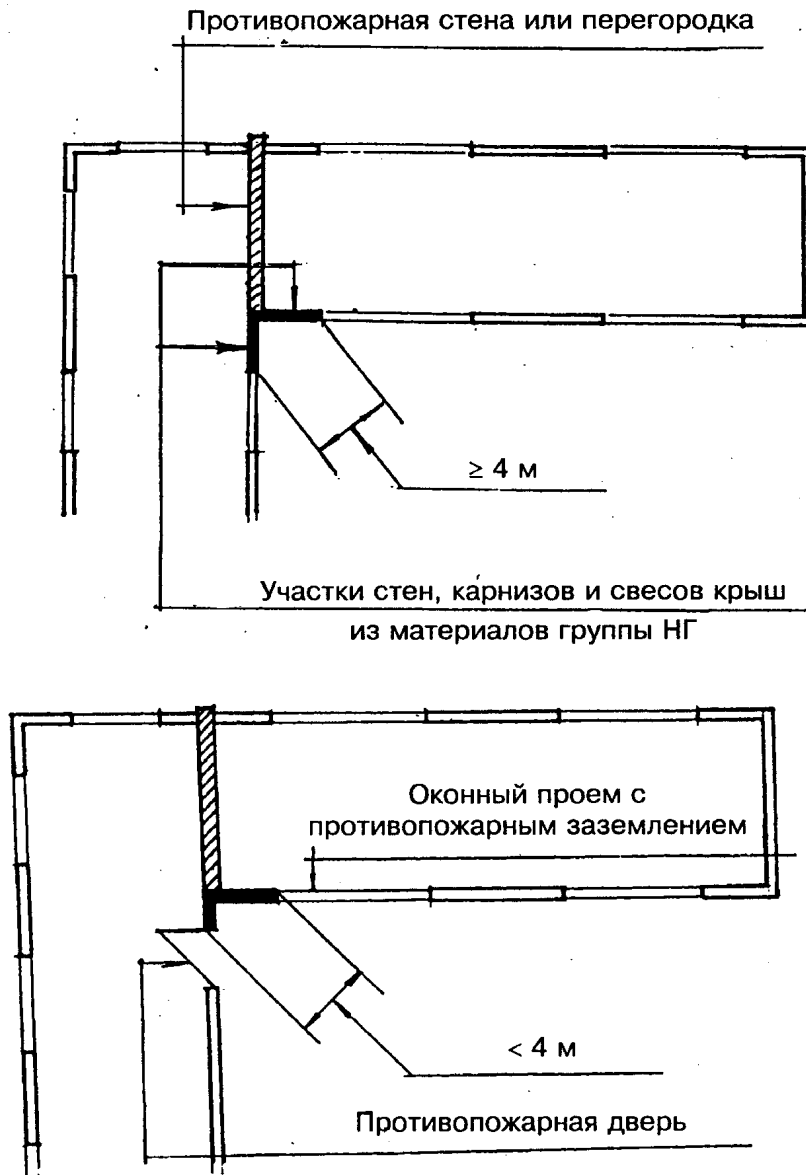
Участок стены в местах примыкания частей зданий под углом, разделенных противопожарными стенами
